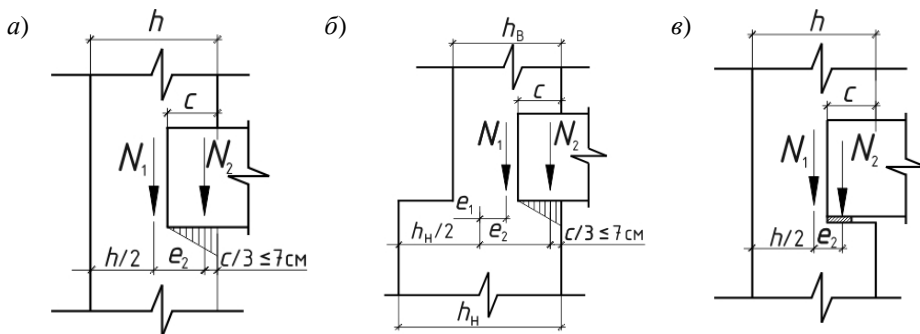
Схемы приложения вертикальной нагрузки:
